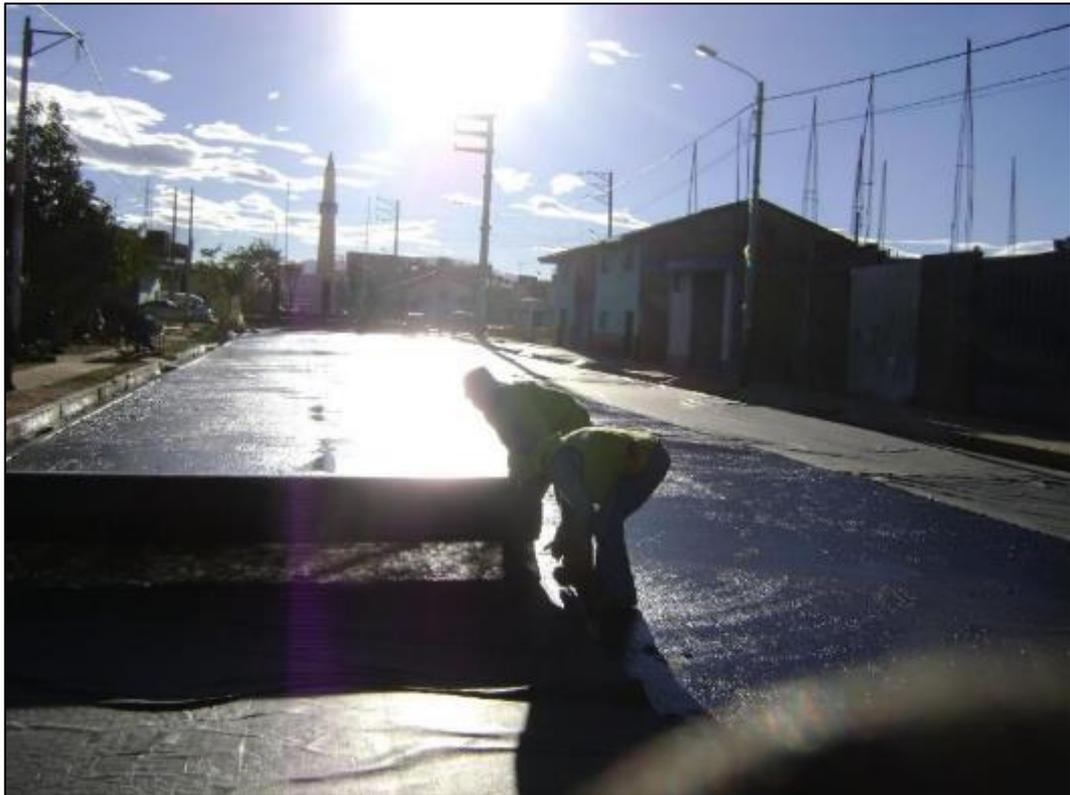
Tendido del geotextil tipo REPAV 450.
